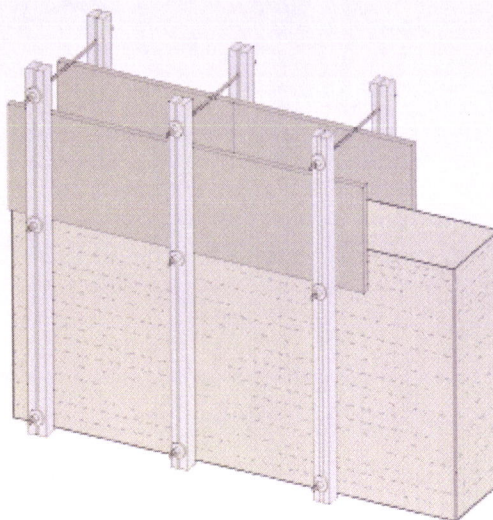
Exemplificação de molde para construções em terra crua.¹⁷
